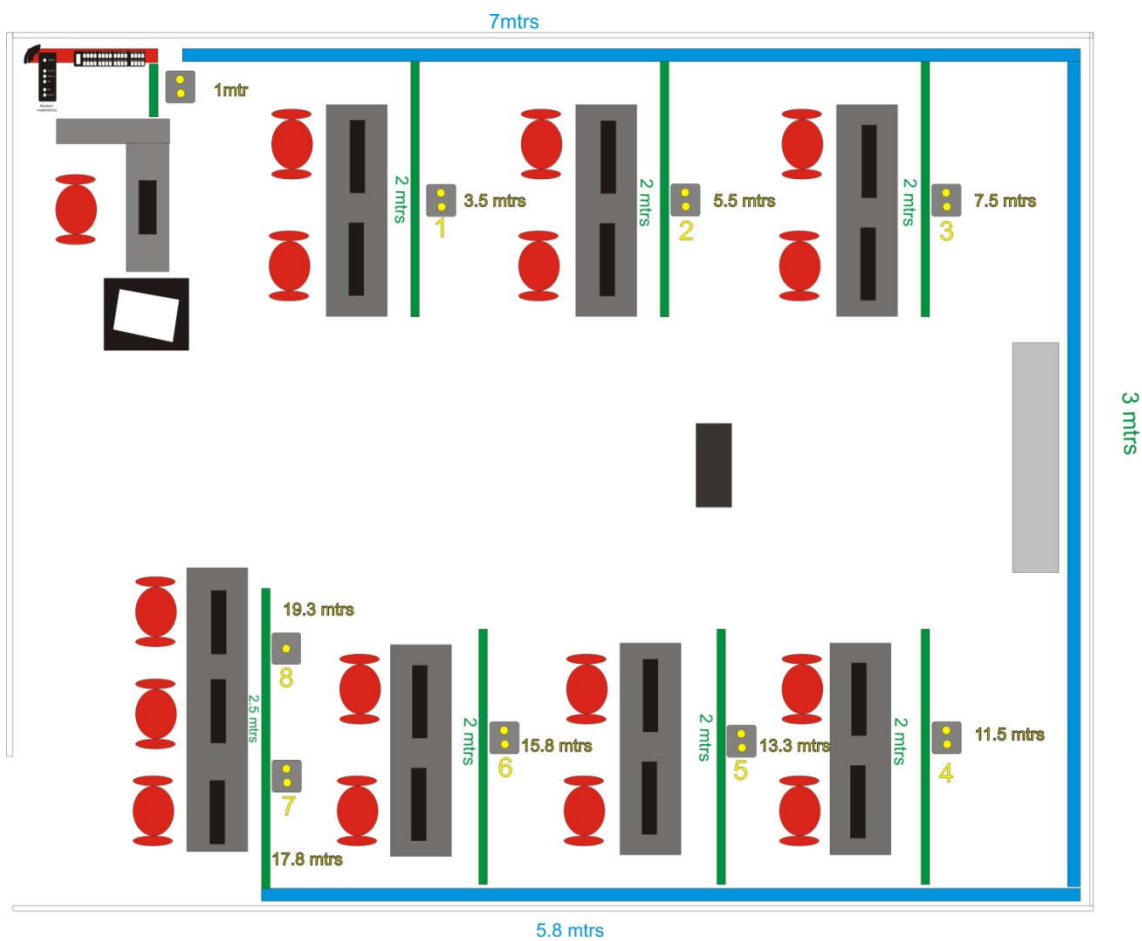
Diagrama estructural del cableado y Wall Place
